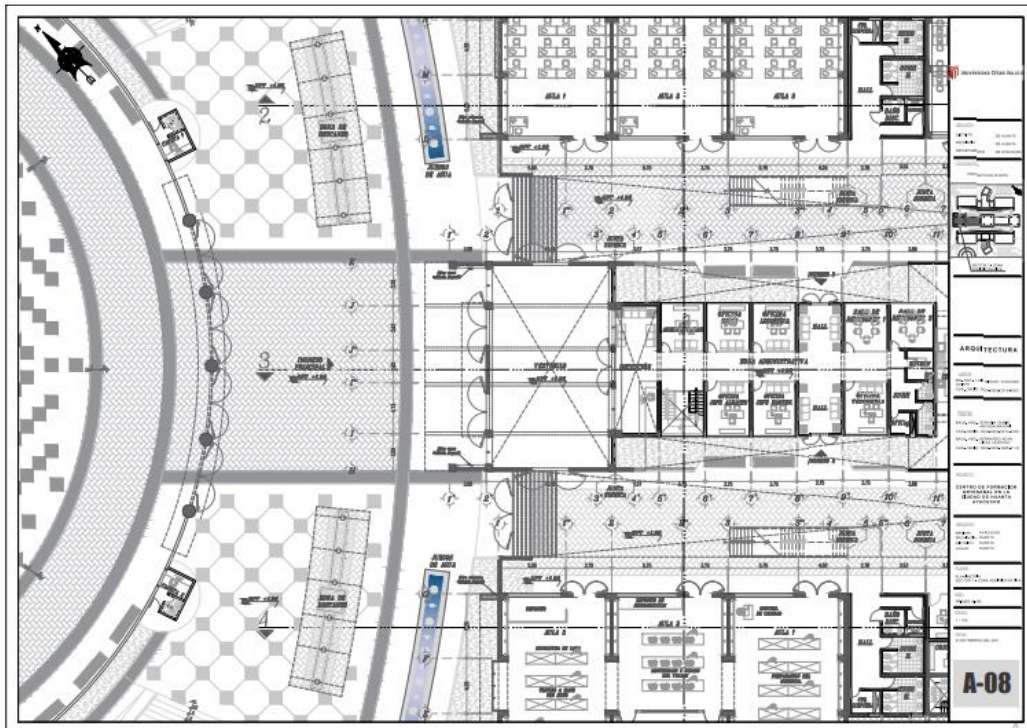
Planimetría del sector 1 ubicado en el piso 1 escala 1/100.
